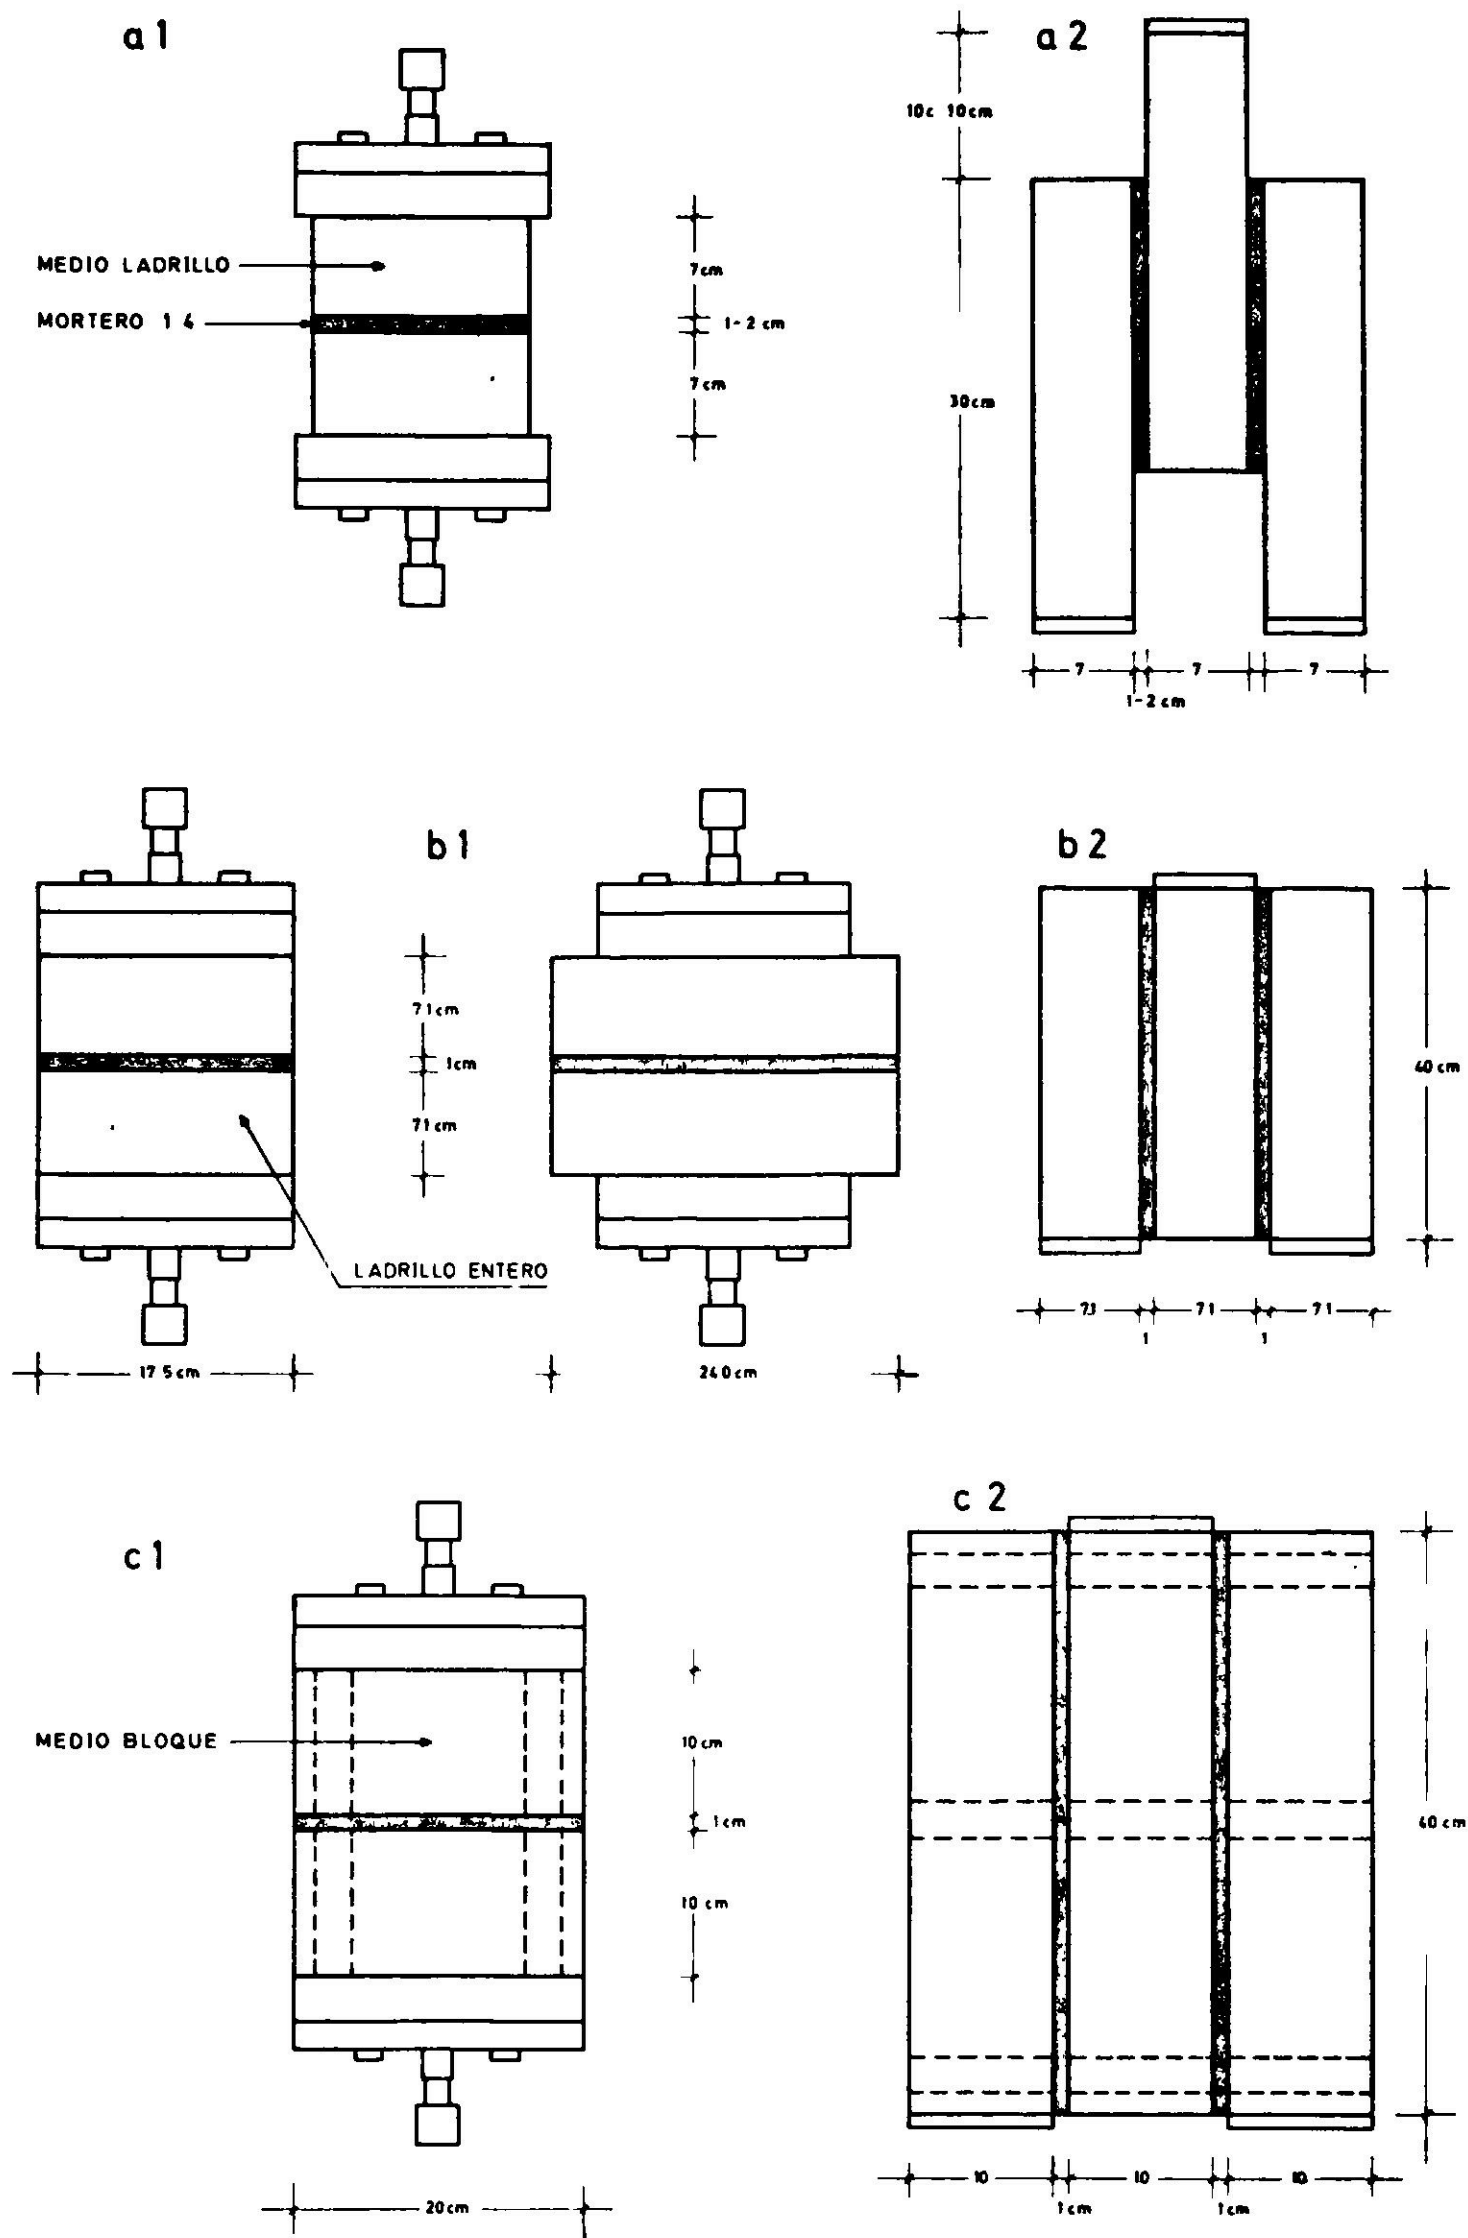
Forma y dimensiones de las probetas para ensayo de tracción y de cizalle. a1) tracción ladrillos de chonchón, a2) cizalle ladrillos chonchón; b1) tracción ladrillos de rejilla, b2) cizalle de ladrillos de rejilla; c1) tracción bloques huecos, c2) cizalle bloques huecos.
